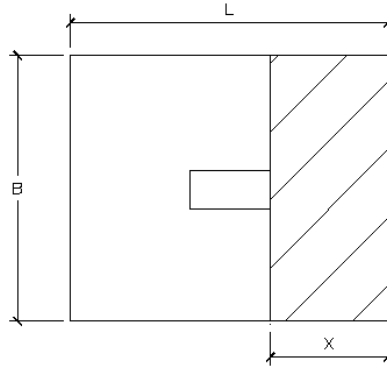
Esquema de las dimensiones para el diseño por flexión.
